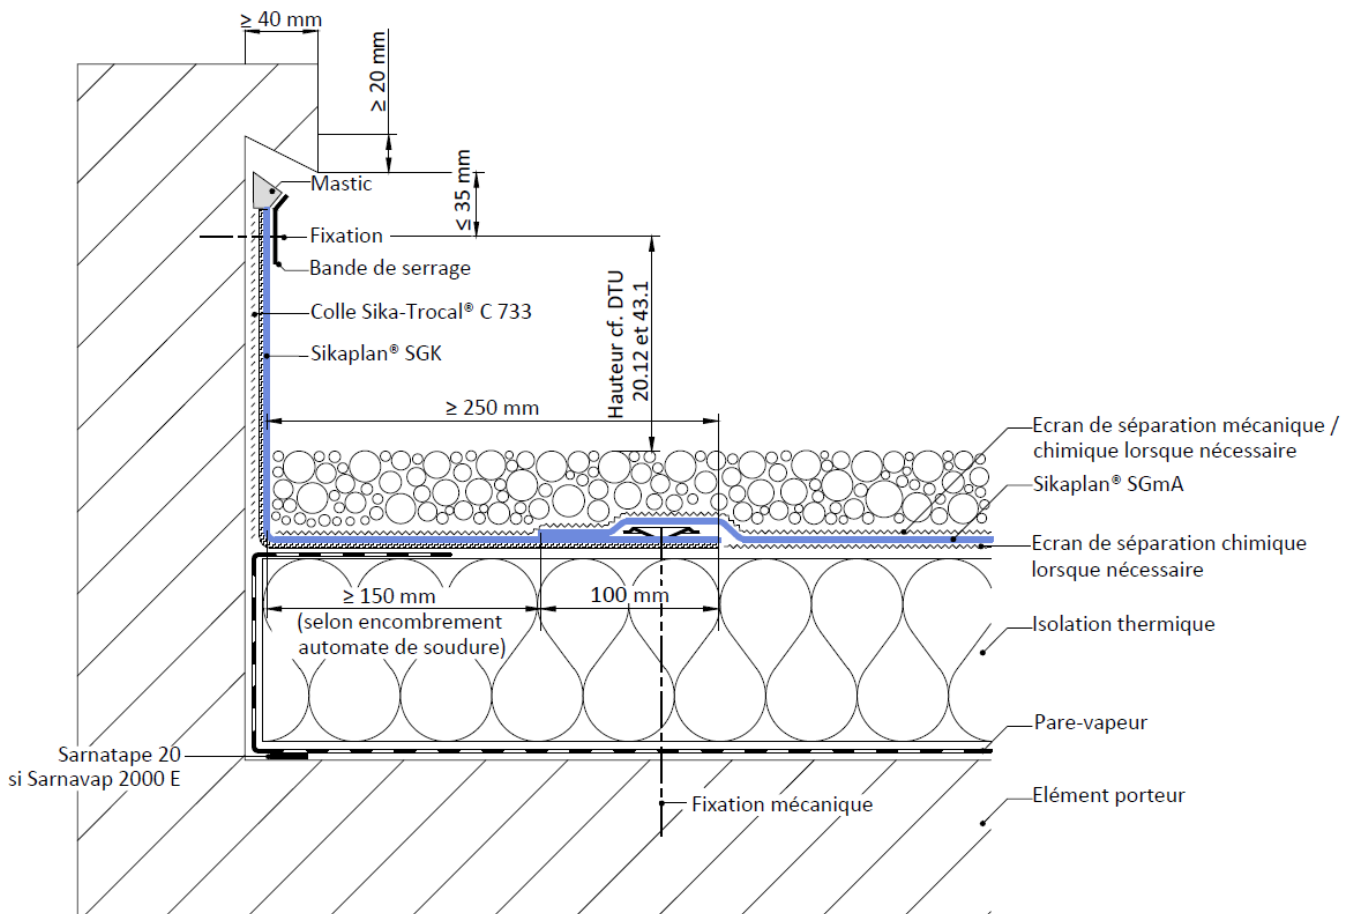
Relevé d'étanchéité sous engravure en Sikaplan® SGK collé – Travaux neufs ou de réfections sur maçonnerie Elément porteur avec état de surface « lissé » au sens du DTU 21
